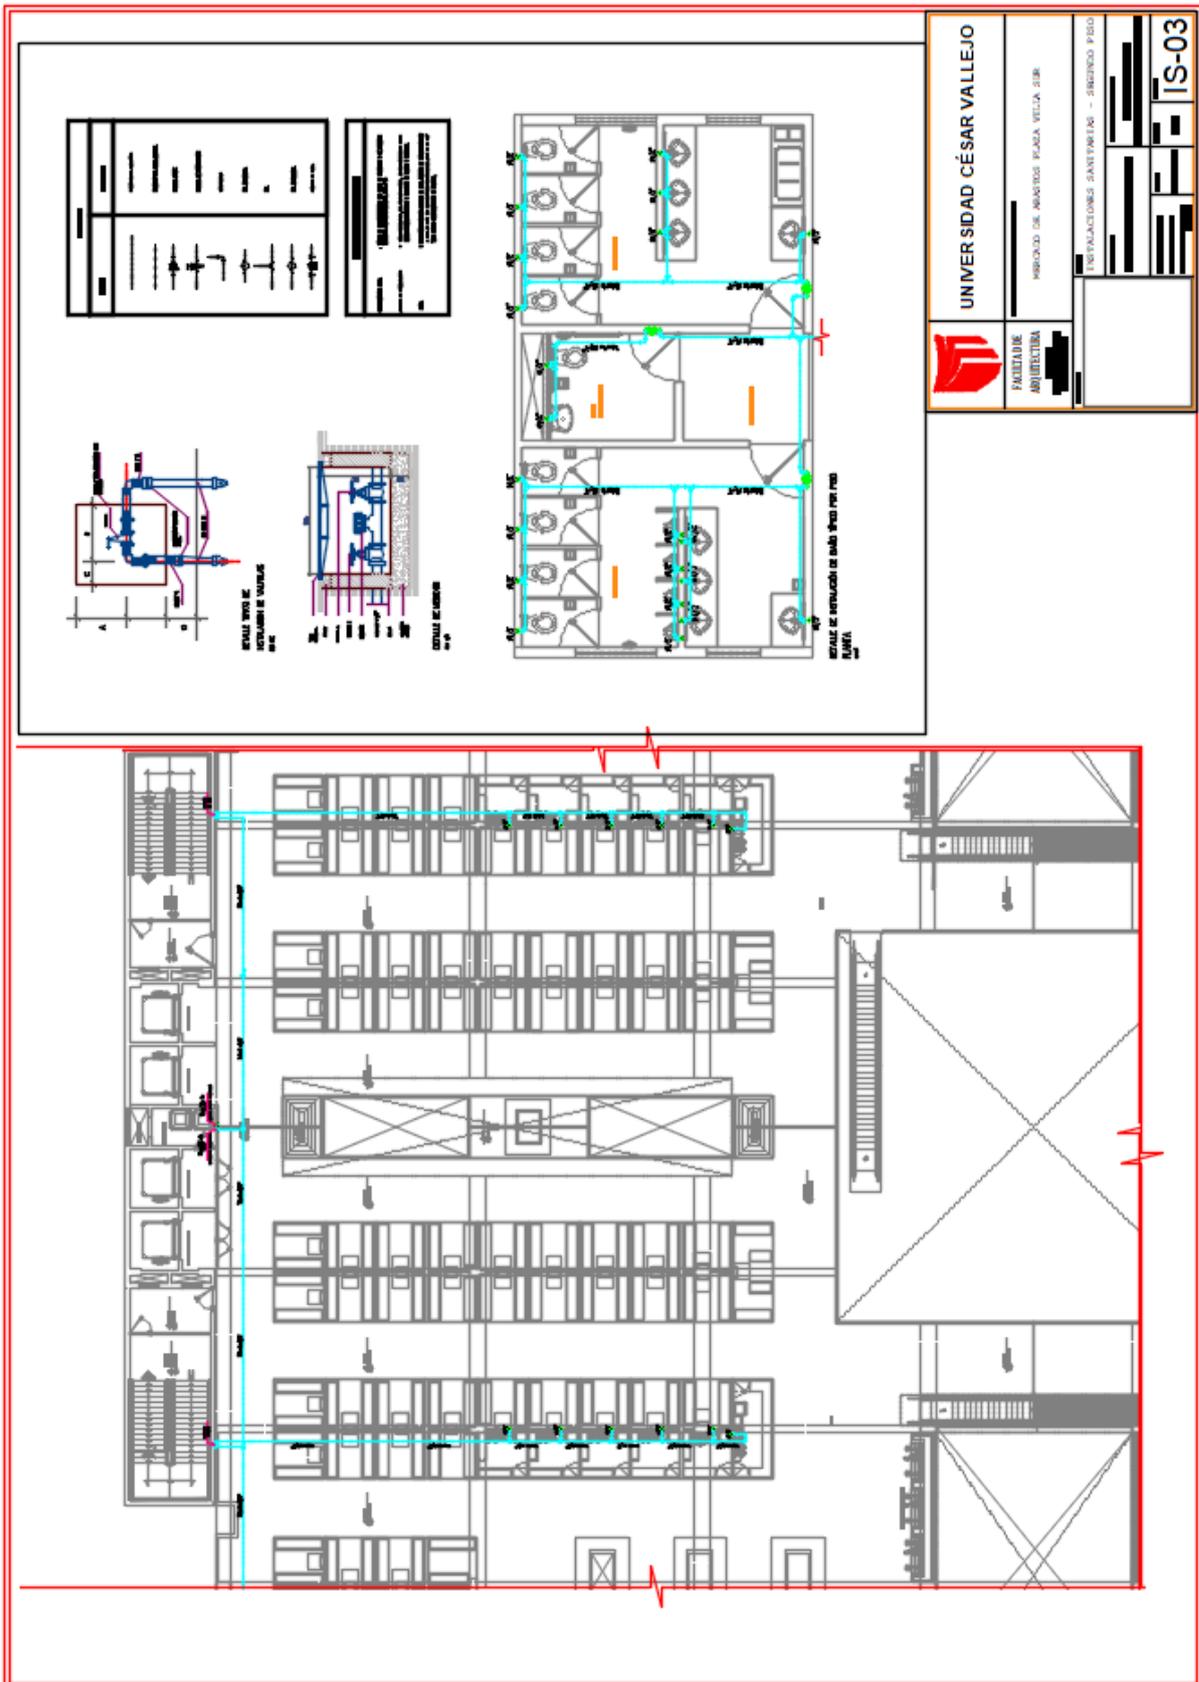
Plano de Sanitarias – Plano de instalaciones de Agua – segundo piso.
